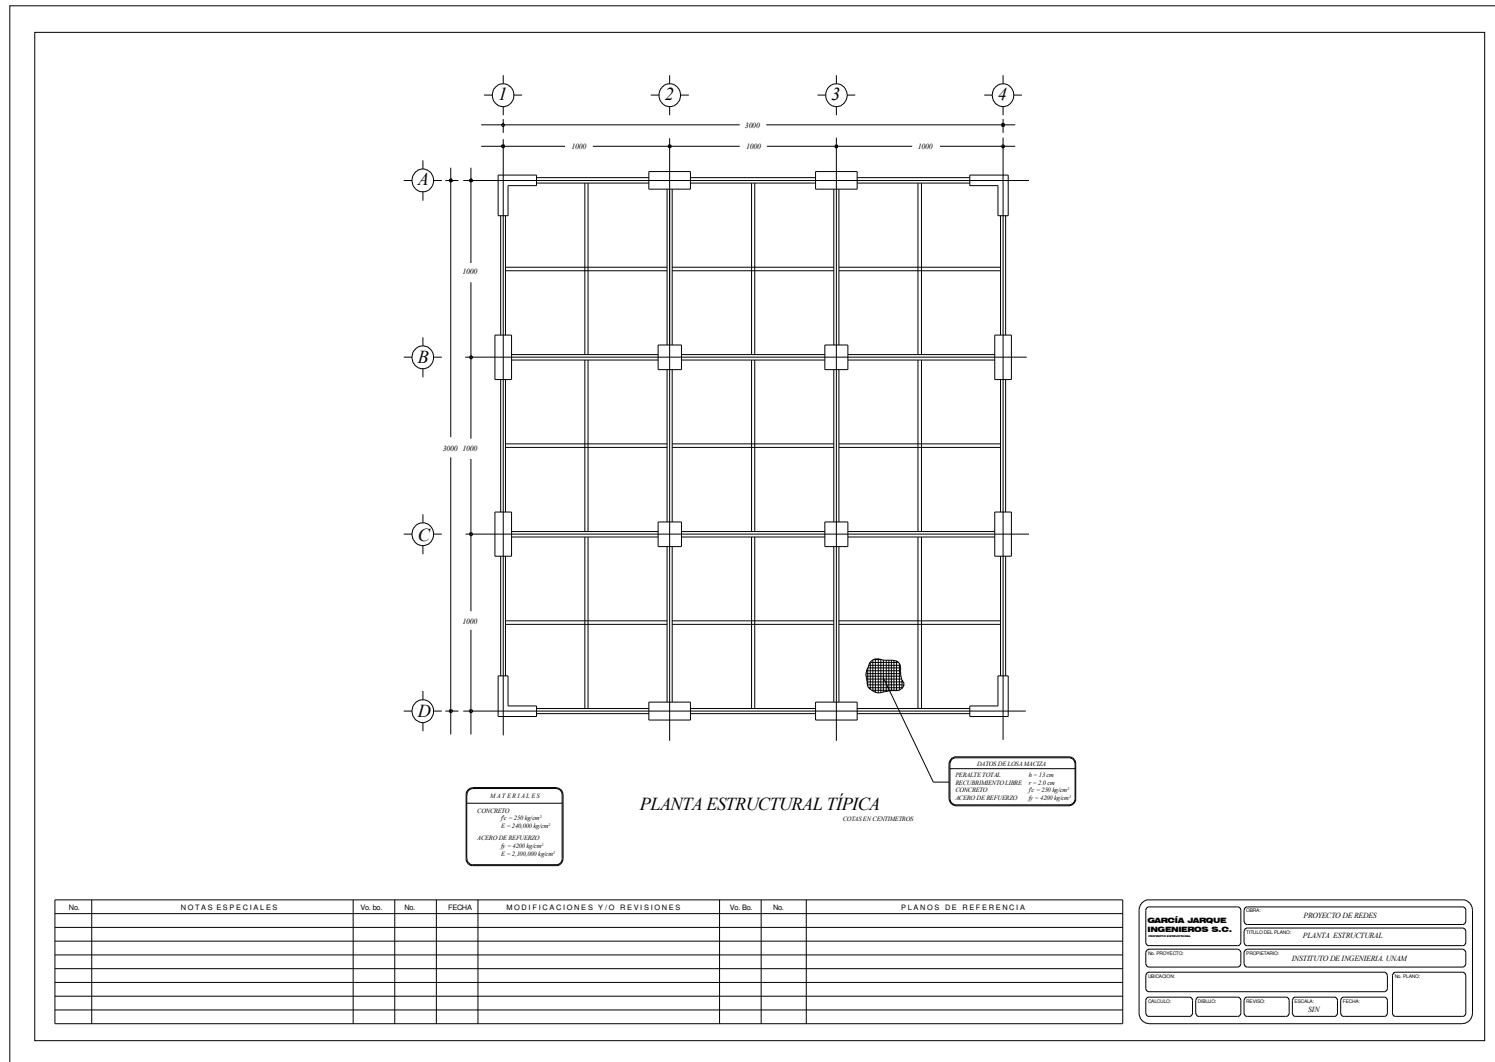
Secciones estructurales del edificio de 10 niveles
